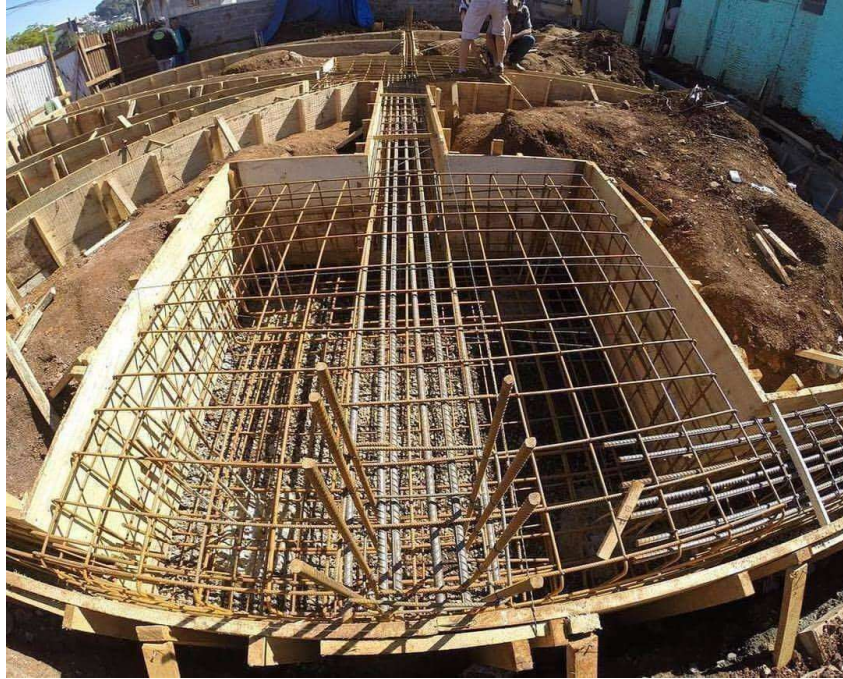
Armadura do pilar, viga baldrame e bloco estão amarradas entre si.
